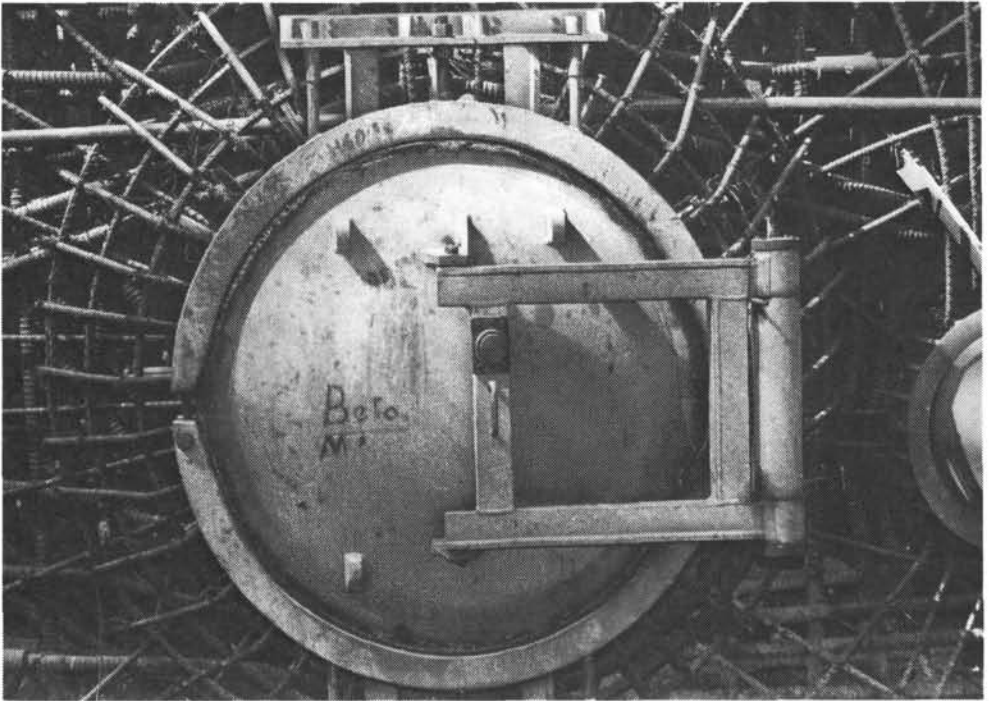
Una penetración de acceso anclada en la malla de armadura de acero.
